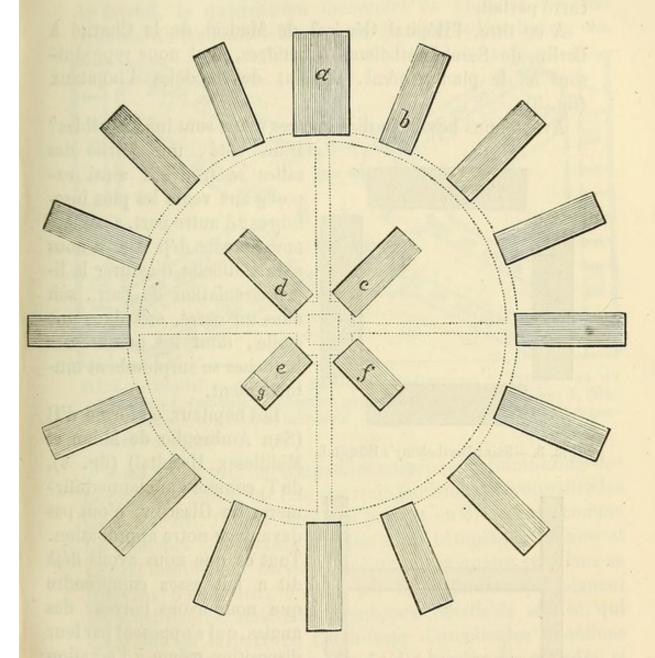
Hammond general Hospital. Plan du rez-de-chaussée : a, bureaux de la direction; b, salles de malades; c, cuisine; d, lingerie; e, maison de garde; f, knapsack room; g, chambre des morts.
